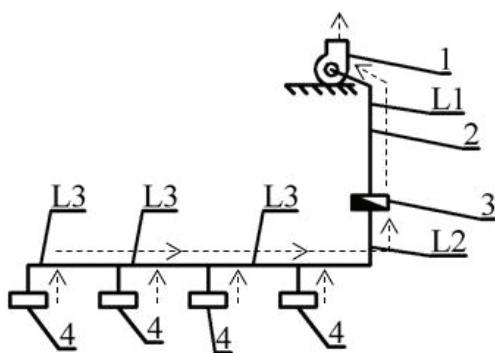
Принципиальная схема вытяжной системы дымоудаления с механическим побуждением: 1 – вентилятор; 2 – воздуховод; 3 – клапан дымоудаления; 4 – дымоприемное отверстие (решетка); L1, L2, L3 – длина участков воздуховода; -> – направление движения дыма.
